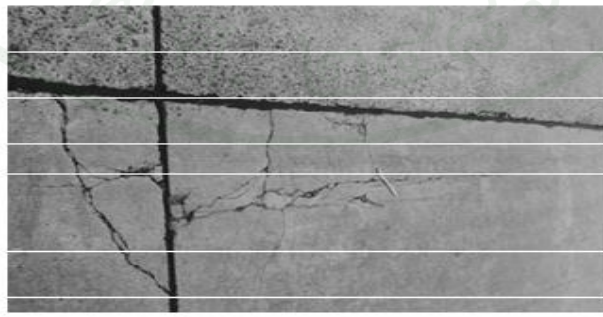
ความเสียหายแบบ Spalling
